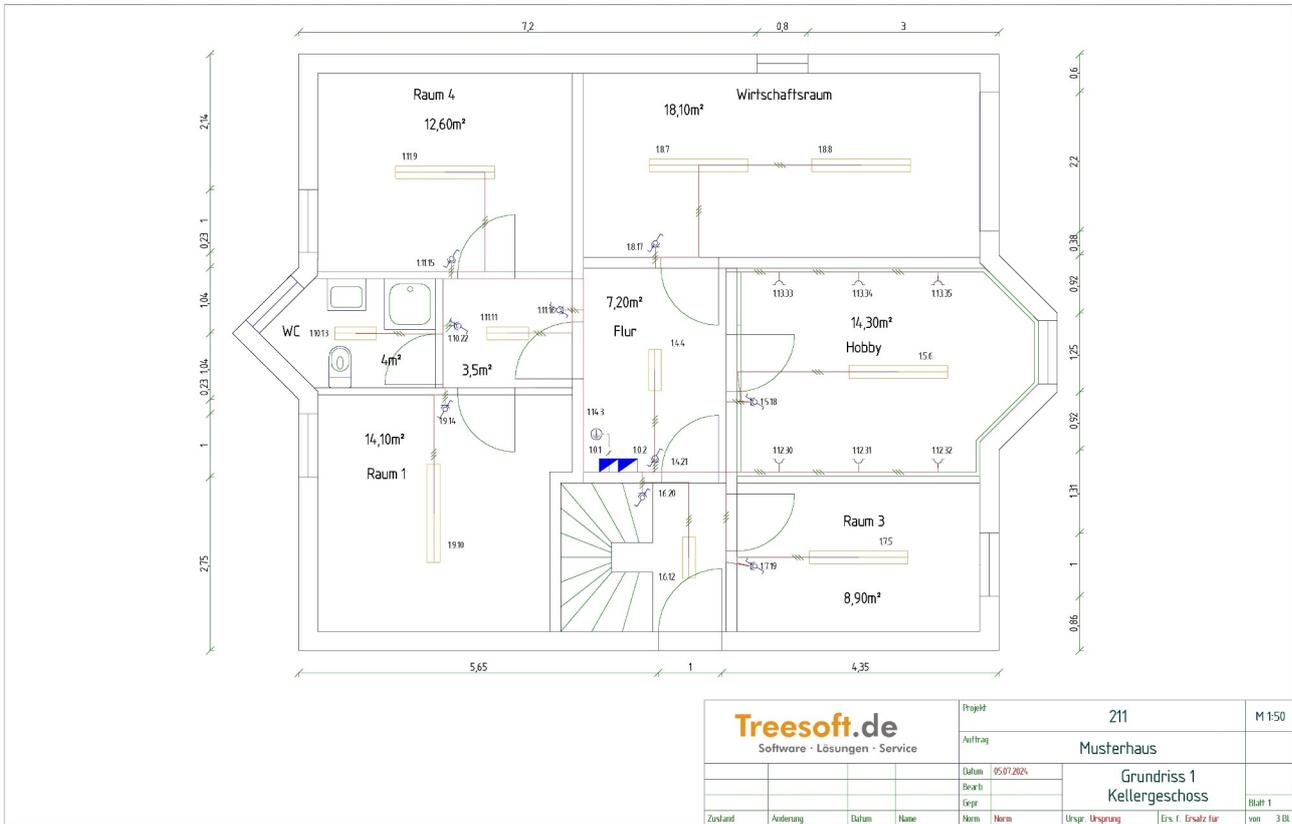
Kellergeschoss (Grundriss 1)
